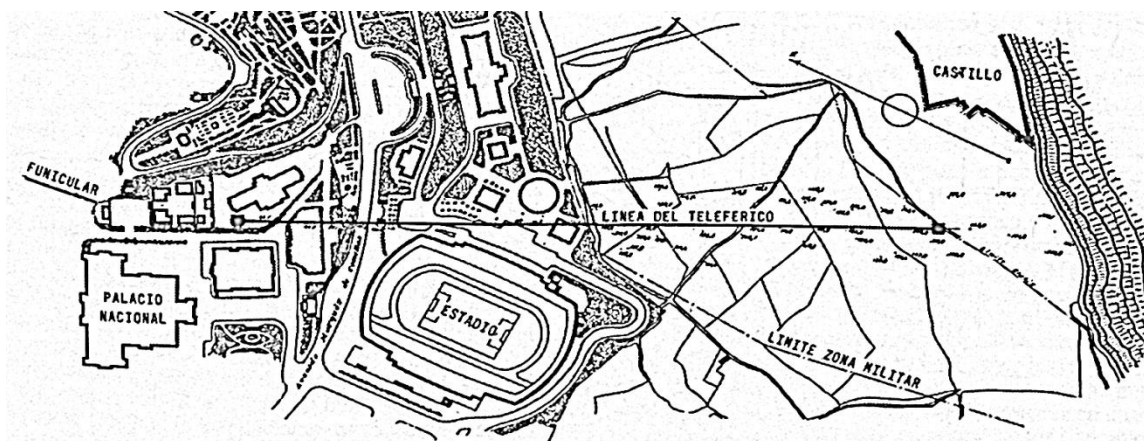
Plano de situación del proyecto de teleférico en Montjuich [7]
